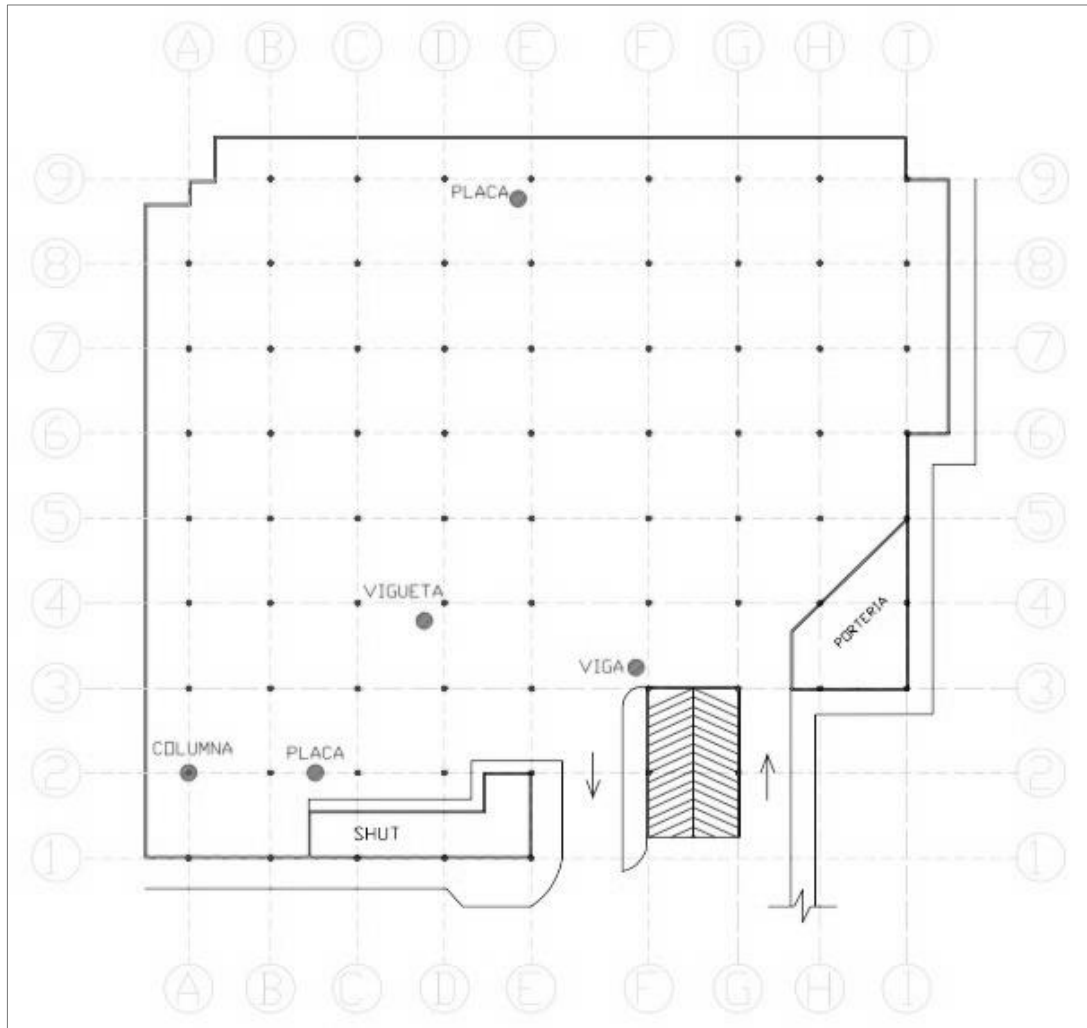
Plano de ubicación de los puntos donde se realizó pruebo de esclerómetro. Fuente: elaboración propia.
